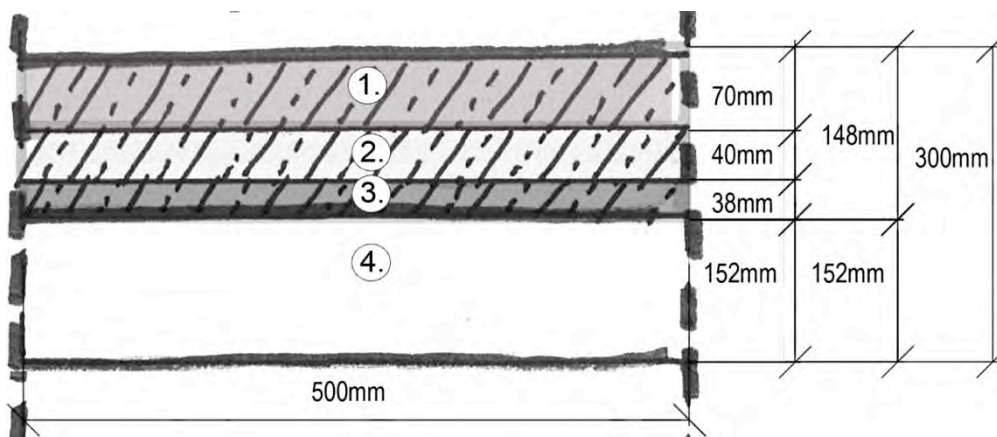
Durchschnittliche Betonmenge, = 148mm Beton Bestand, kann als Vorlage genutzt werden, Hohlraumdecke Bestand_30cm_7cm
